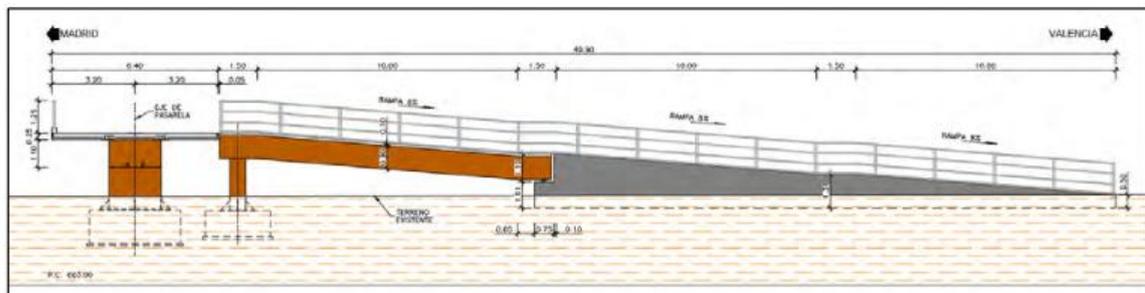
Alzado longitudinal rampa de acceso PAS 9+470
